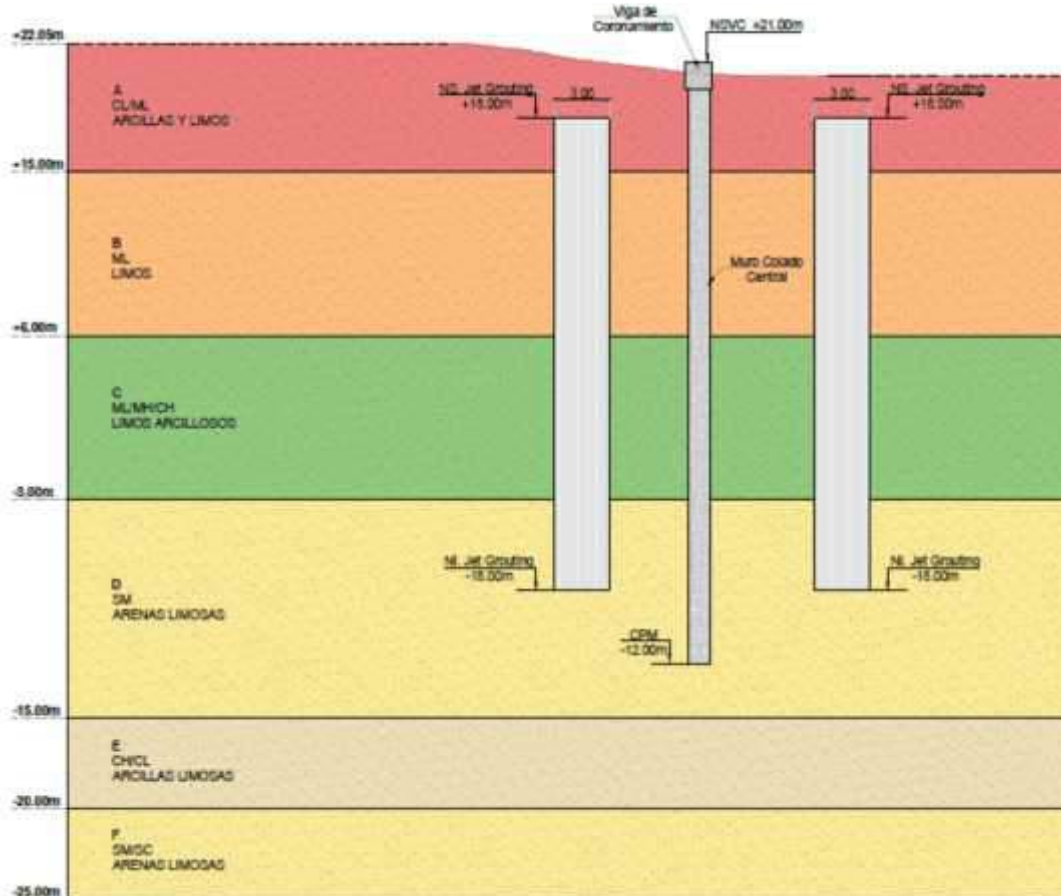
Corte longitudinal de la obra de la pantalla con el suelo mejorado con jet grouting por el eje de las laderas
